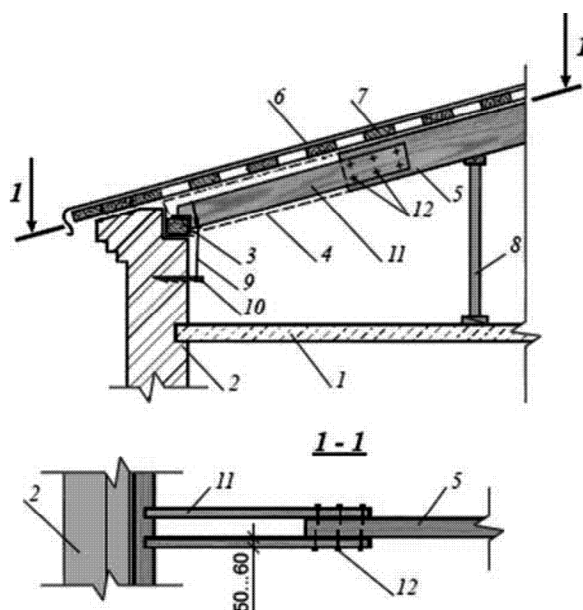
Усиление концов стропильных ног деревянными накладками:
